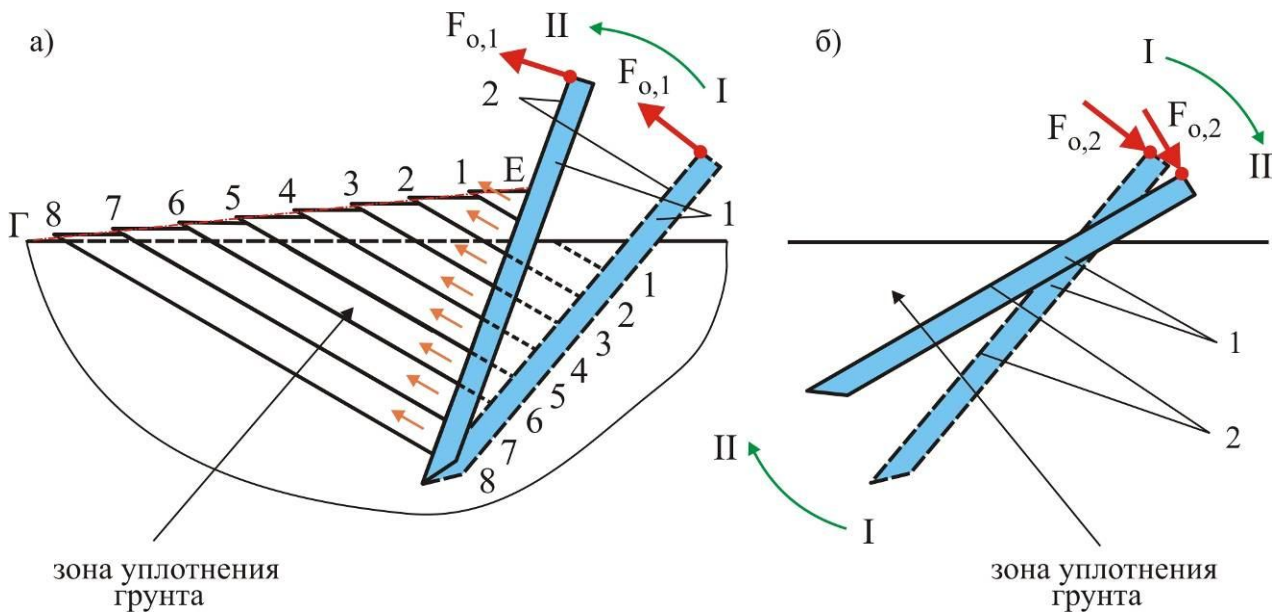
Схема разрушения грунта при наличии анкеровки [14, 17]:
